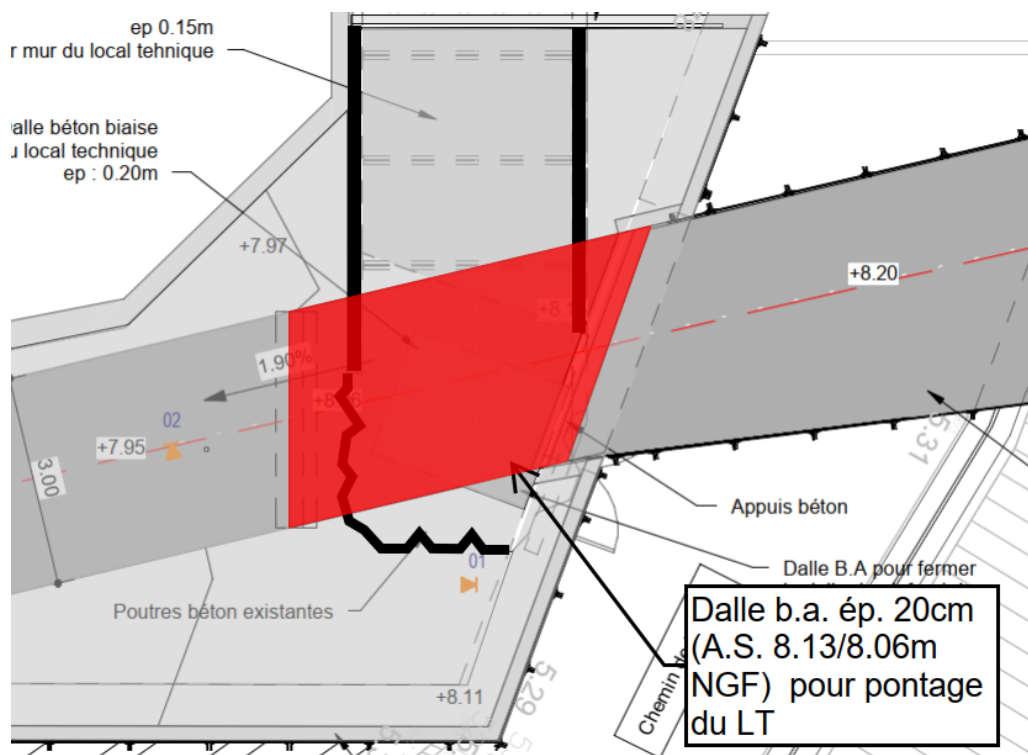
rive gauche - dalle b.a. ép. 20cm de pontage du LT
